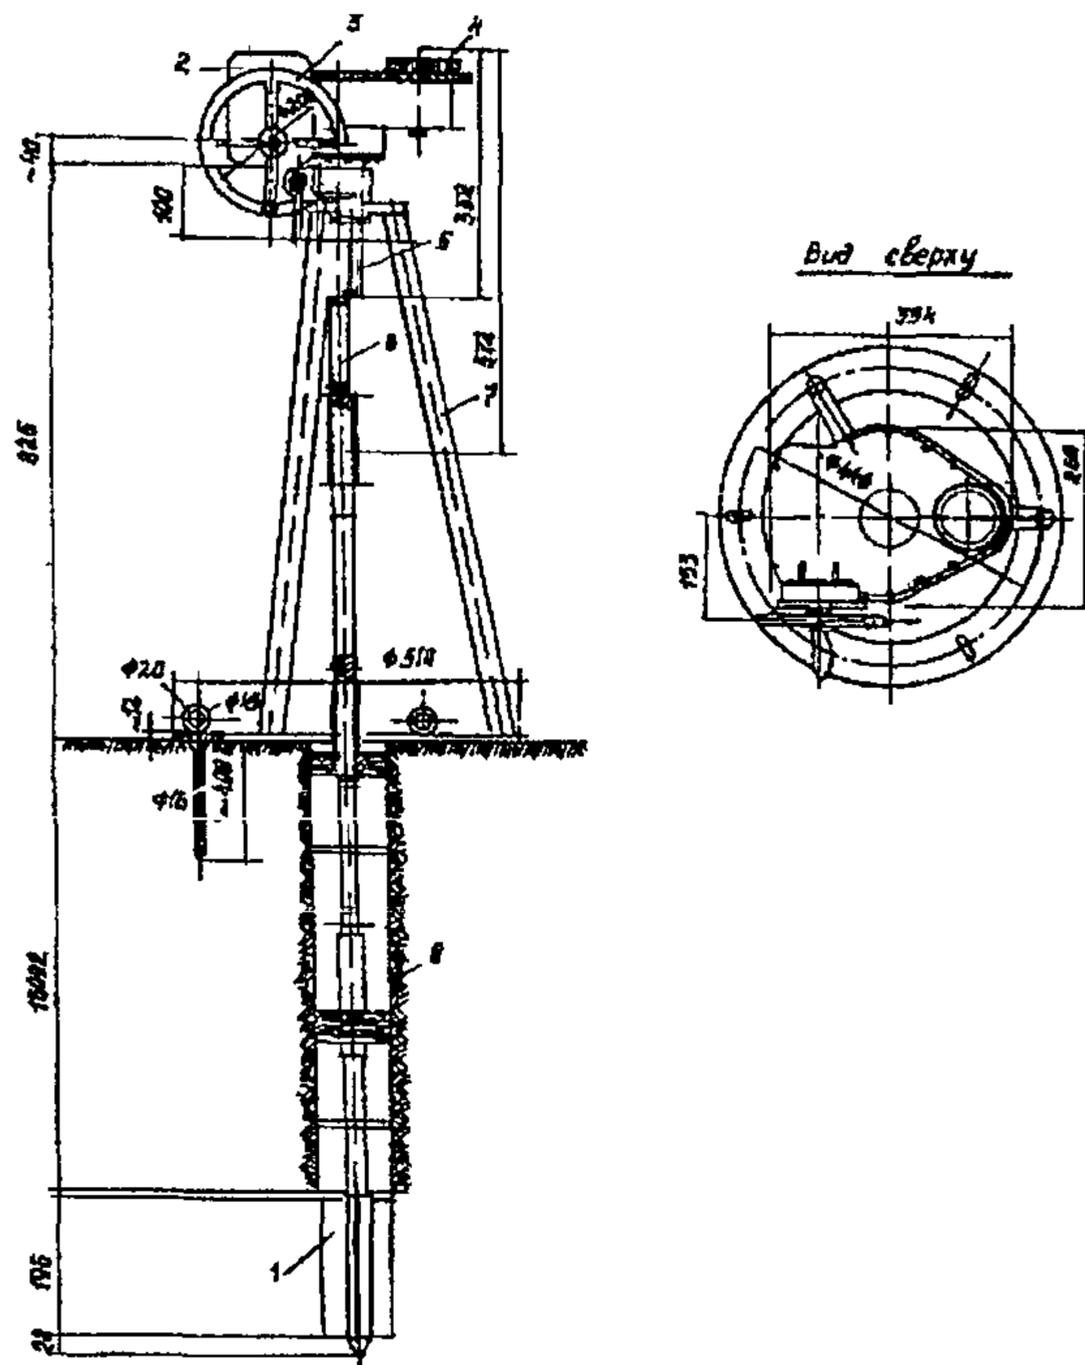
Общий вид лопастного прибора СИ-52: 1- крыльчатка; 2- головка прибора; 3- маховик; 4- лимб; 5- задвижное устройство; 6- колонна штанг; 7- стаянна; 8- центрирующее устройство.
